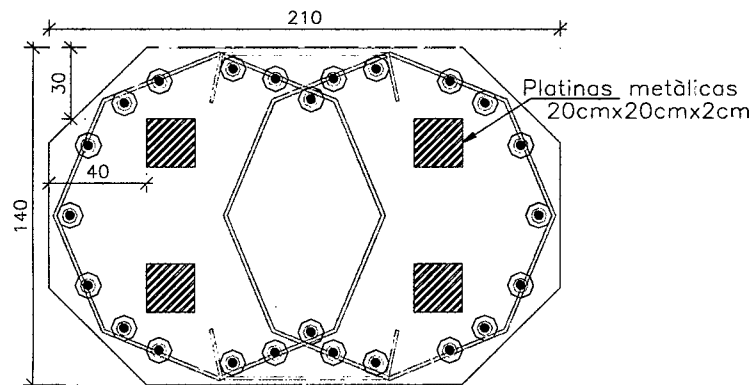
Esquema en planta de ubicación de platinas metálicas (20cmx20cmx2cm) de apoyo en la columna.
